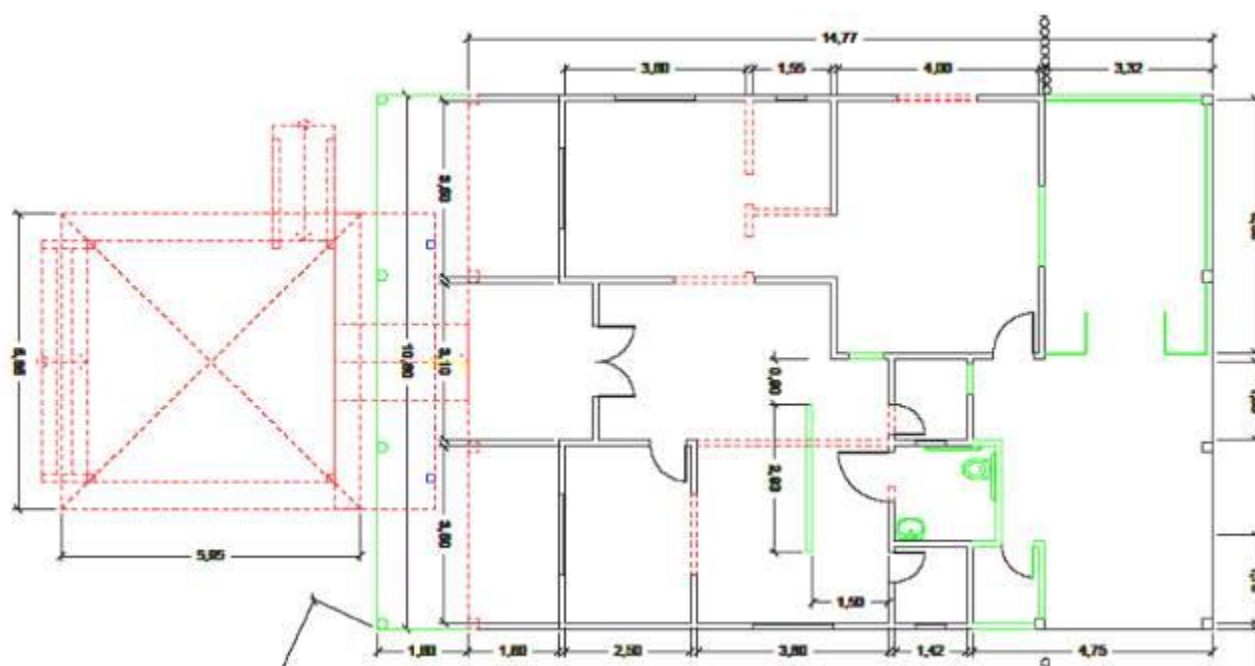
planta baixa da edificação receptivo/escritório, com indicação de demolições (vermelho) e construções (verde).
